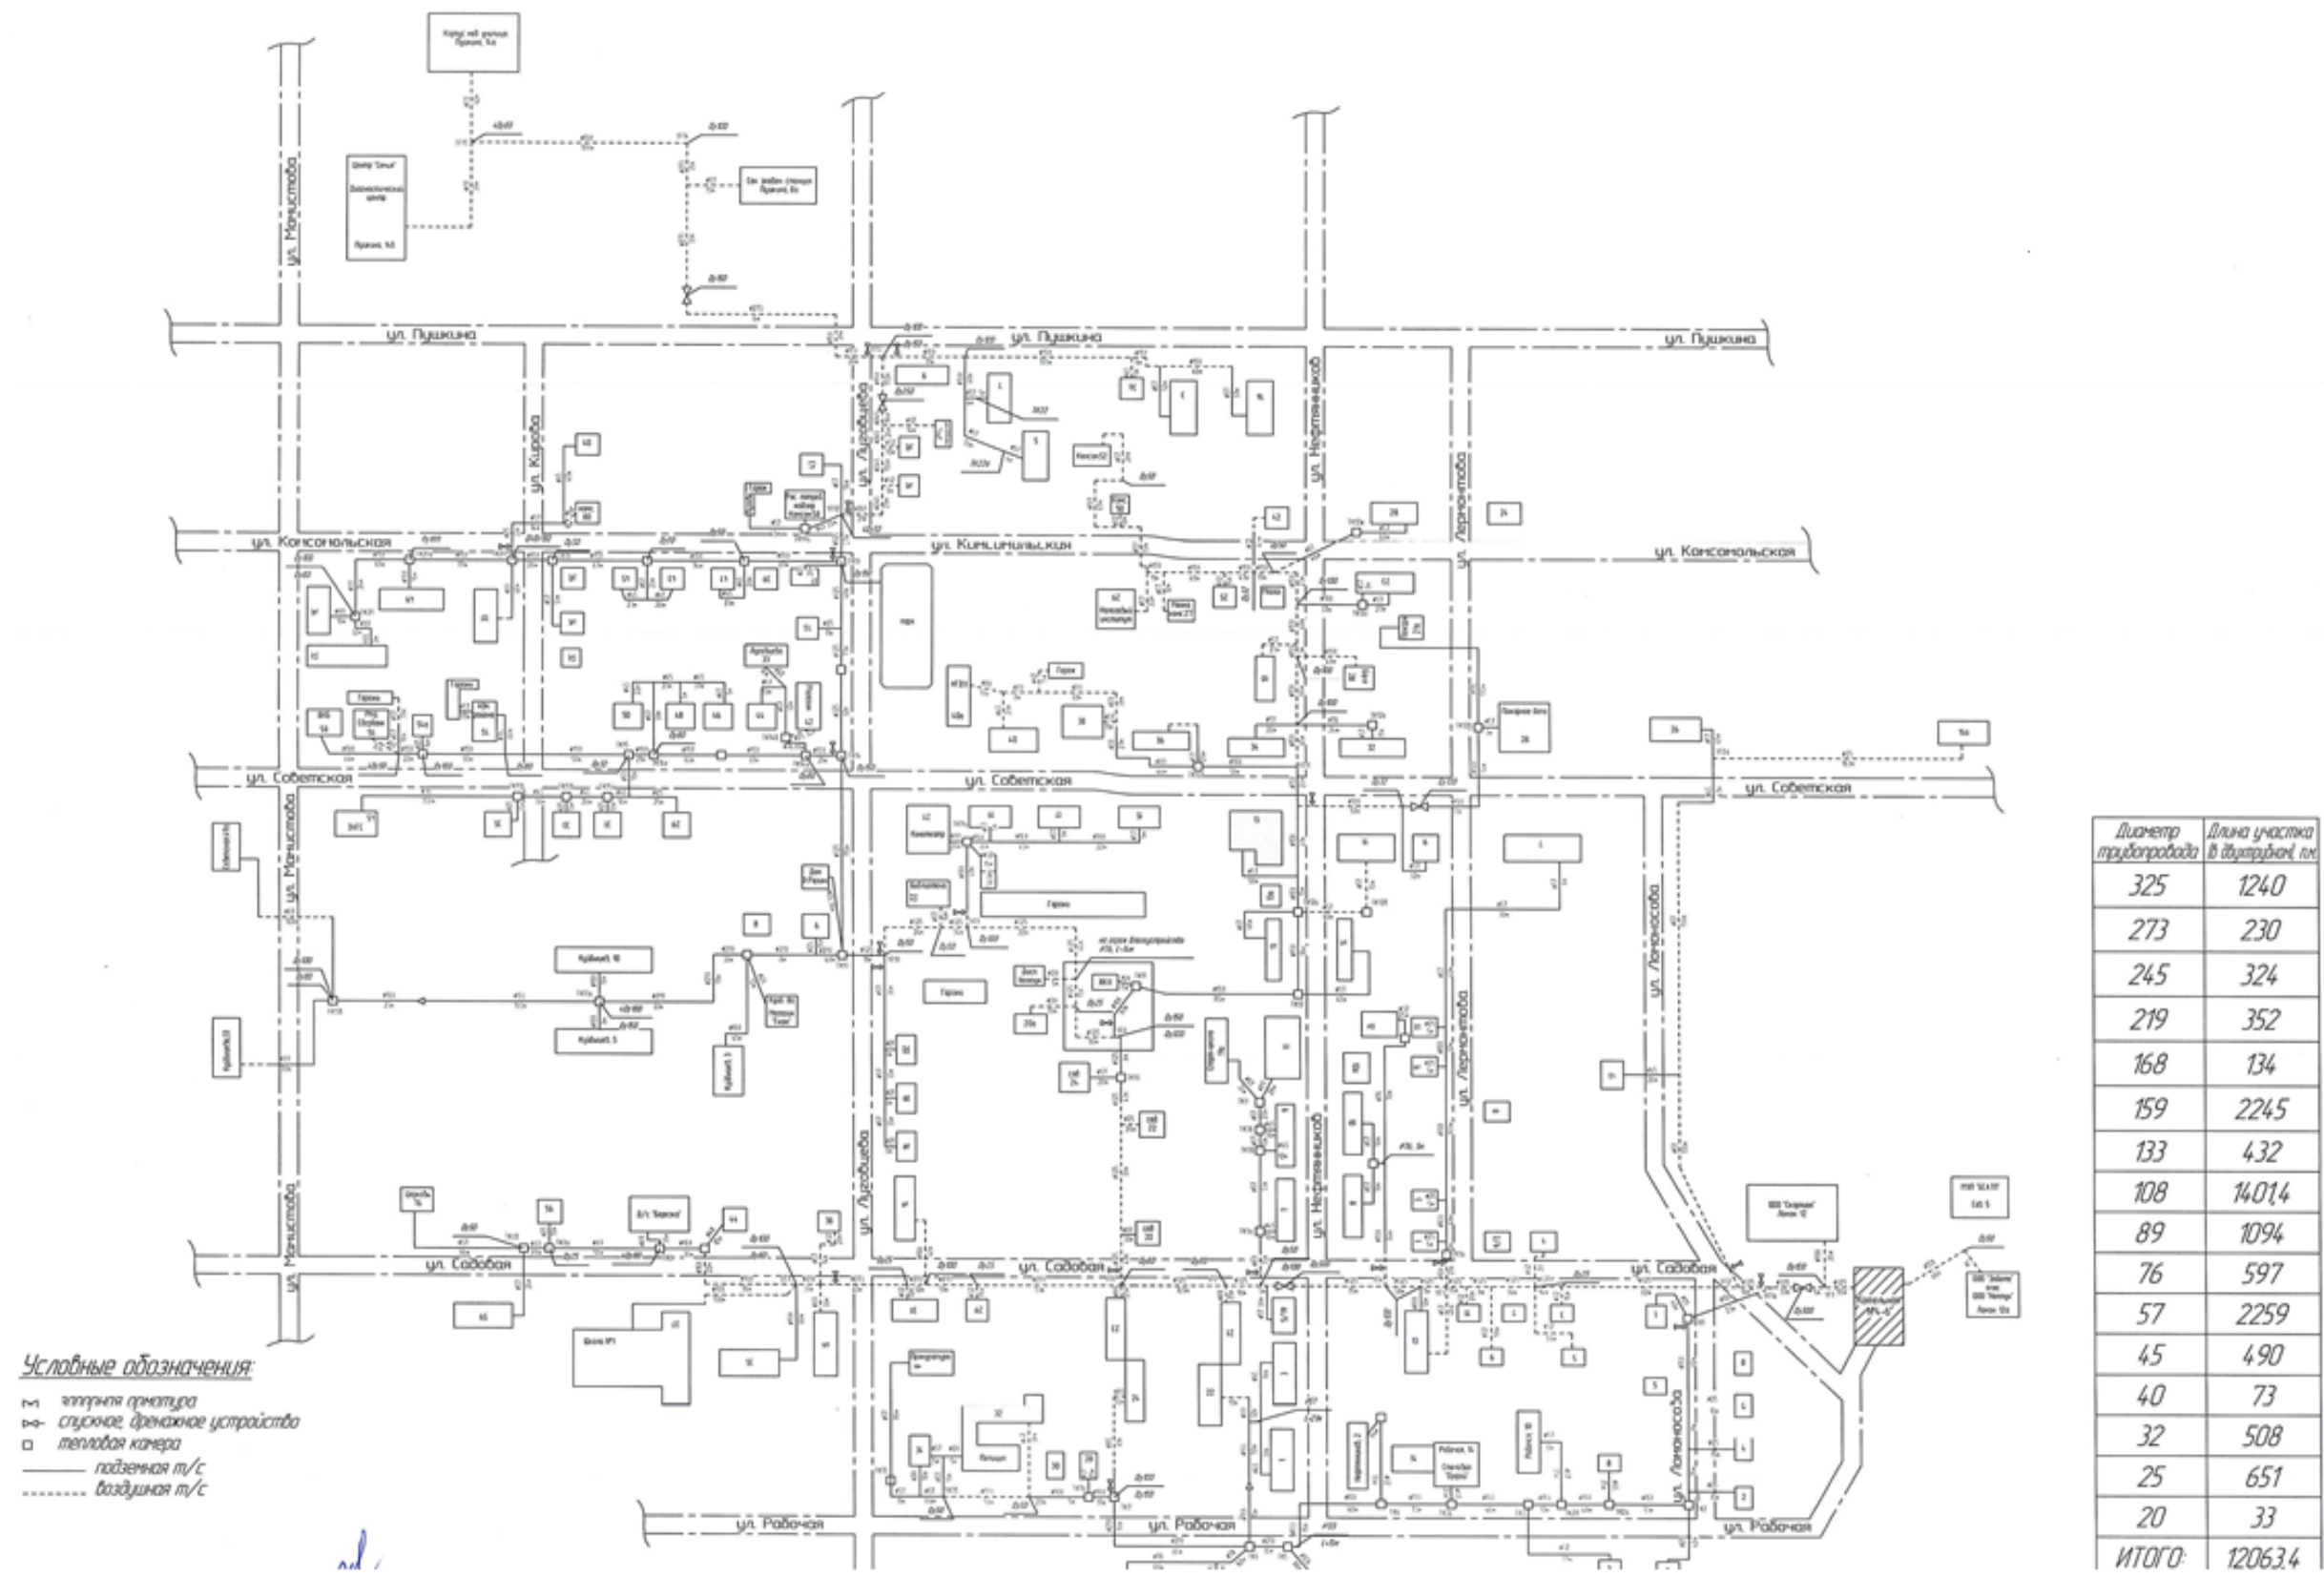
Схема тепловых сетей от здания котельной №6 п. г. т. Безенчук
